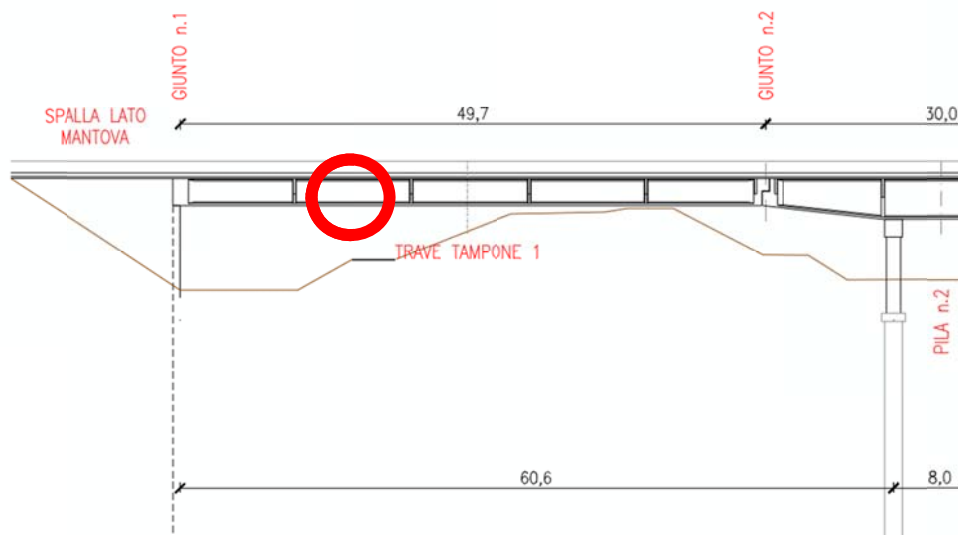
Particolare dell'impalcato a cassone e sezione di verifica
